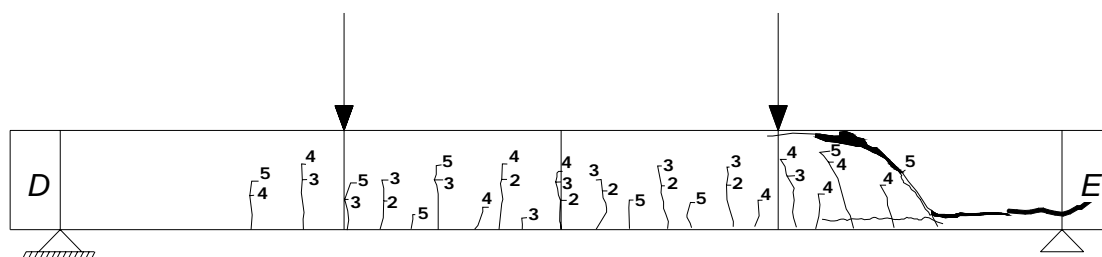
Padrão de fissuração para a viga V70-1 sem armadura transversal
